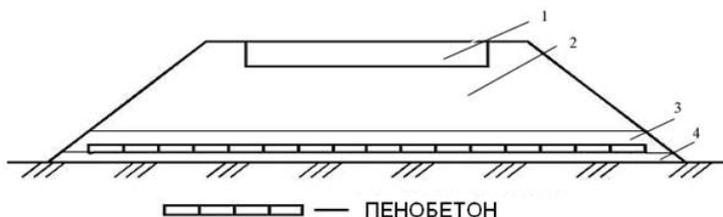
Схема дорожного полотна с использованием двух слоёв монолитного пенобетона, 1 – дорожная одежда, 2 – грунт насыпи, 3 – защитный слой, 4 – выравнивающий слой
